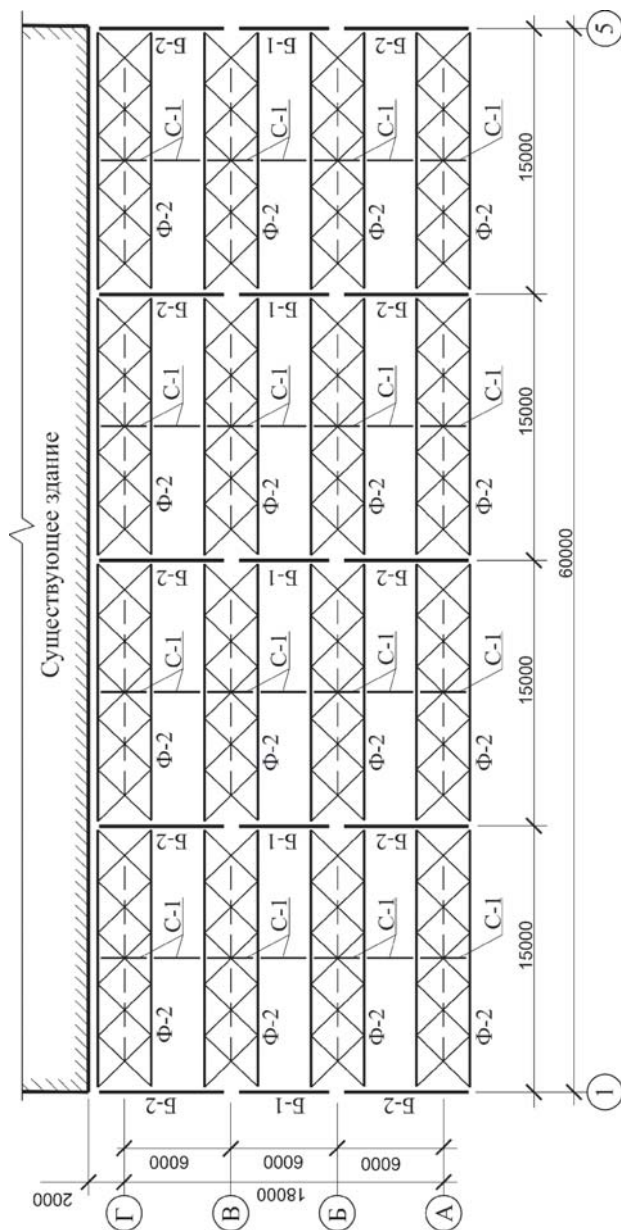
План покрытия (покрытие с фермами пролетом 15 м)
